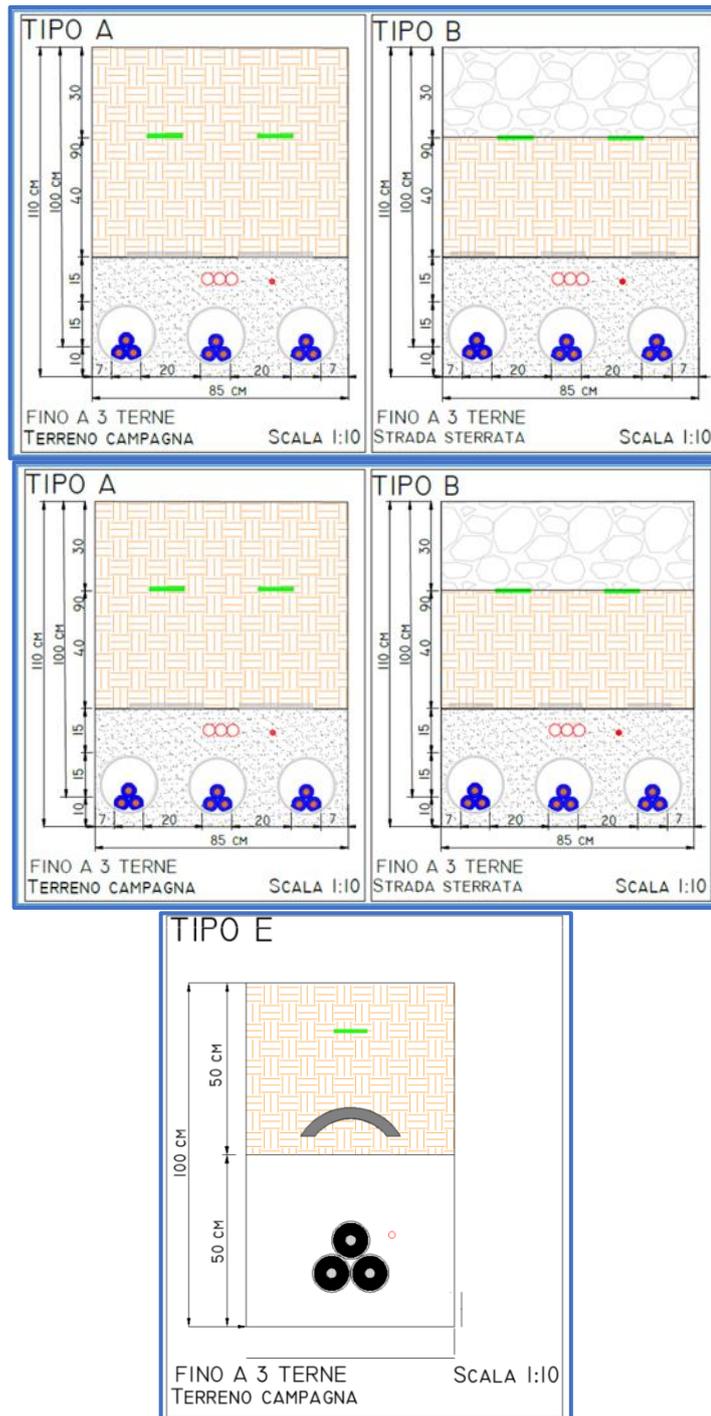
DETTAGLIO CAVIDOTTO MEDIA TENSIONE
